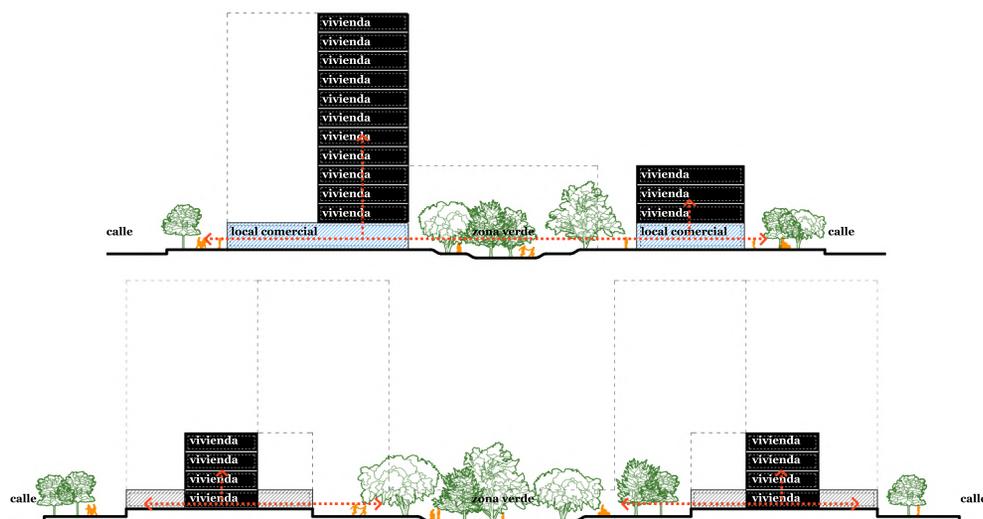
Sección longitudinal y transversal esquemática de manzana tipo.
